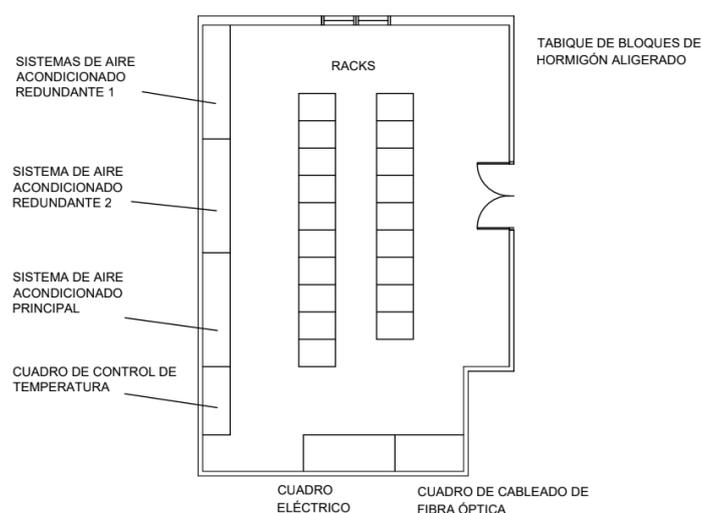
Plano de planta de la nueva distribución de los armarios rack con respecto a las tomas de aire del sistema de refrigeración.
